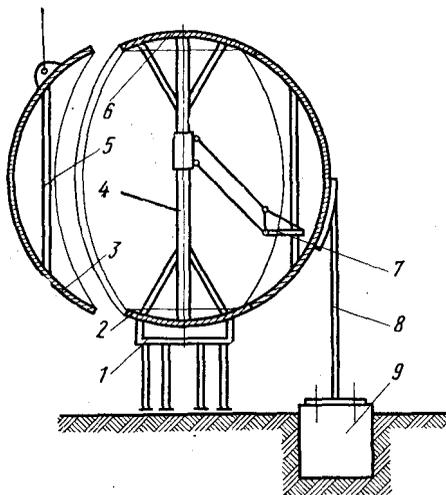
Схема сборки сферического резервуара в проектном положении
